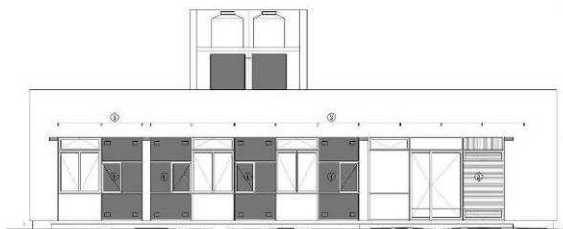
Fachada Norte. Tipología 3 dormitorios.
